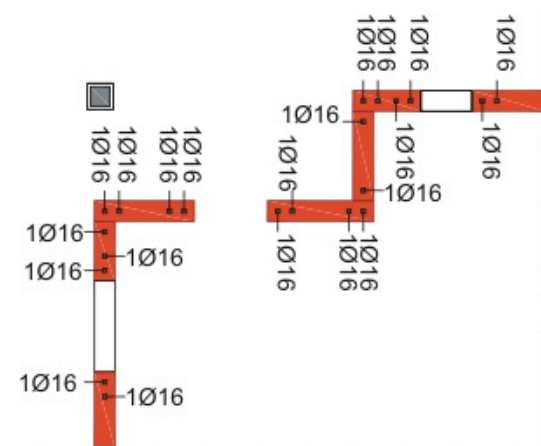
Particolare dell'esecutivo della struttura in muratura armata con indicazione del posizionamento e diametro delle barre di armatura verticale.
